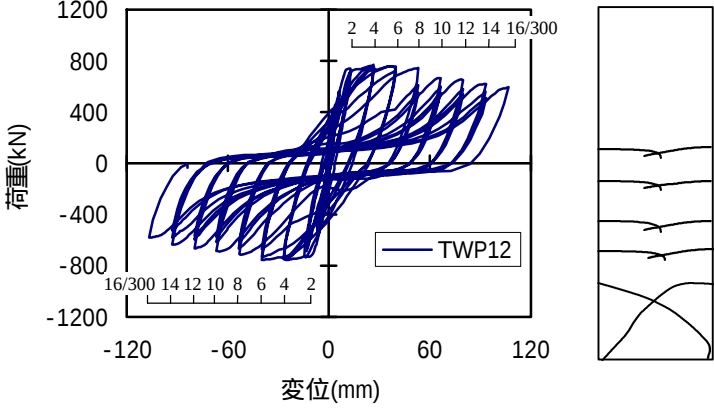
試験体 TWP12 の荷重 - 変位関係とひび割れ状況
